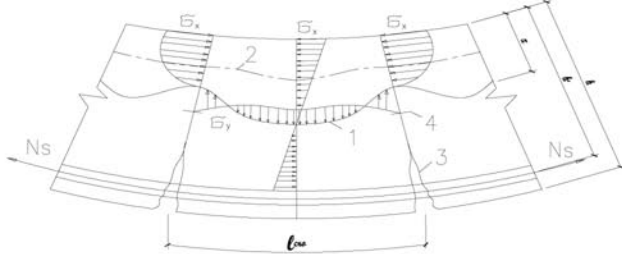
Схема роботи залізобетонної балки без зчеплення арматури з бетоном після утворення нормальних тріщин.
